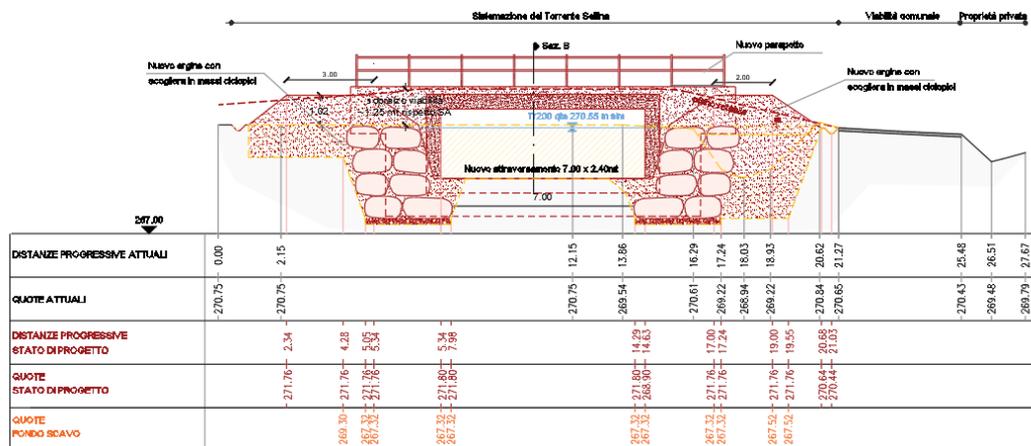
adeguamento del secondo attraversamento - sezione
